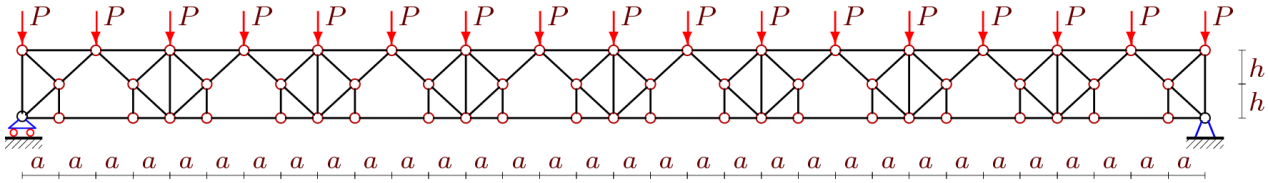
Нагрузка на узлы верхнего пояса, $n = 4$
